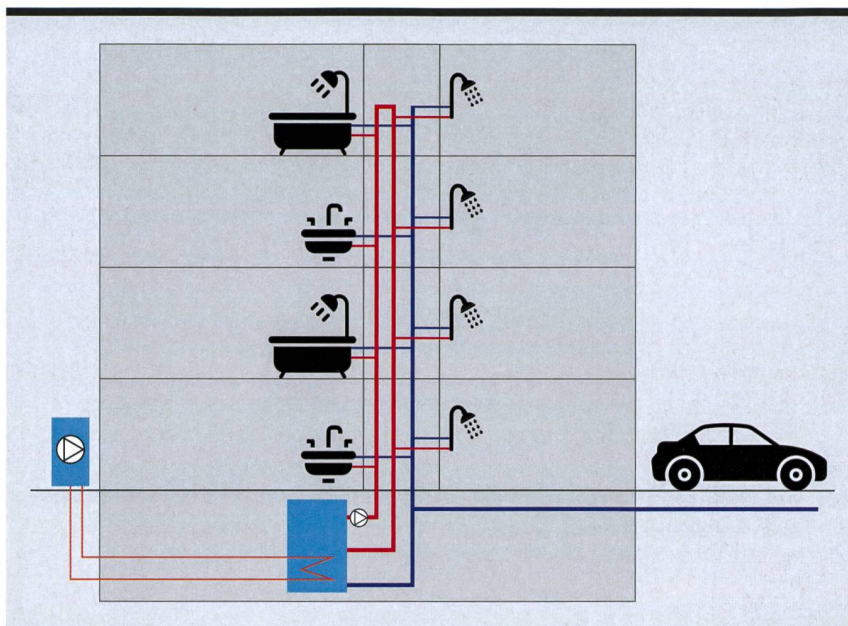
Warmwasserversorgung in einem modernen Wohnhaus: Das Warmwasser für Küche und Bad wird mit einer Wärmepumpe geheizt und über ein gedämmtes Zirkulationssystem verteilt.
